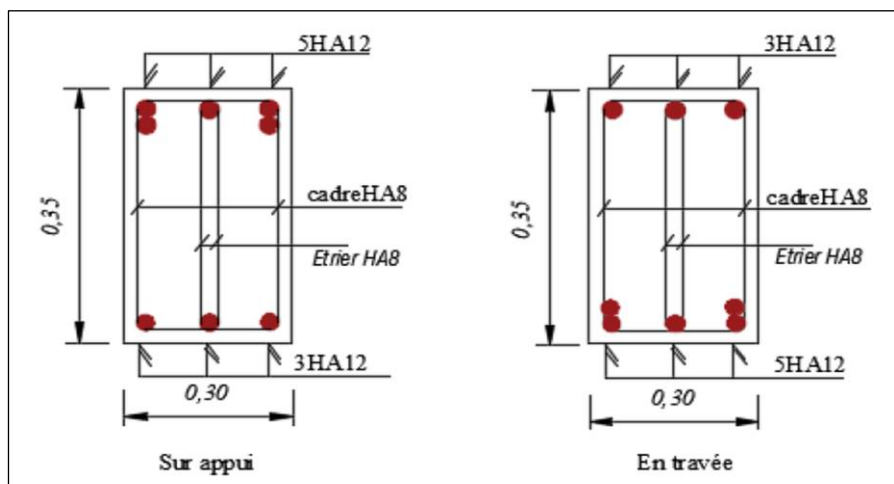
Schèmes de ferrailage des poutres secondaires.
